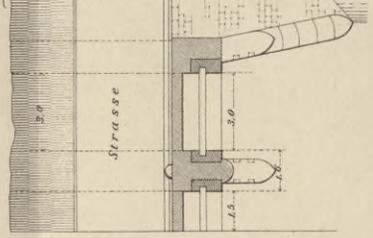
Theil des Grundrisses. (Schnitt EF.)
